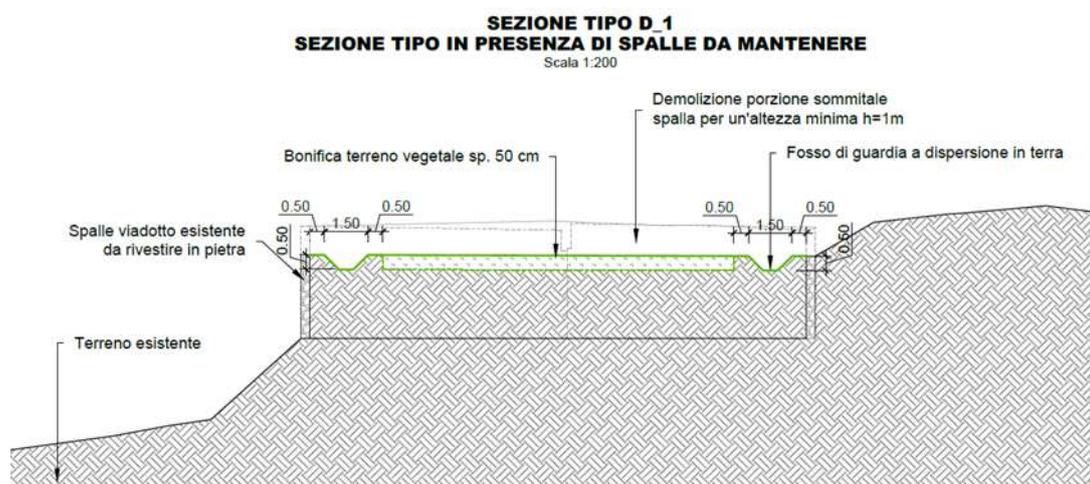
Sezione tipo D_1 in presenza di spalle da mantenere
